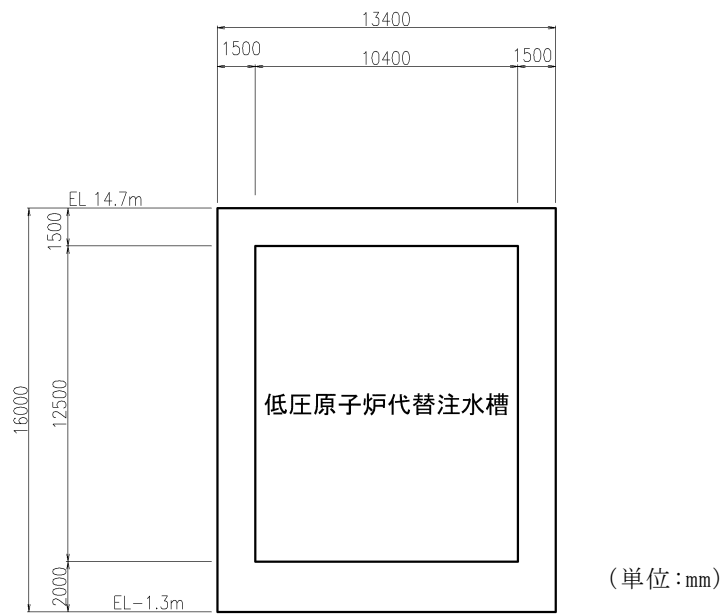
低圧原子炉代替注水ポンプ格納槽 断面図 (B-B断面)
